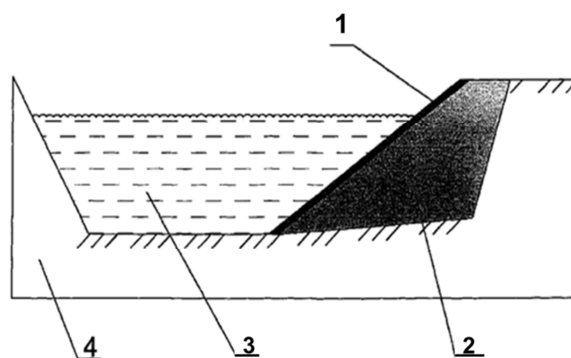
Конструкция водоотводного сооружения: 1 – металлическая подпорная стенка, 2 – конструкционный пенобетон, 3 – вода, 4 – грунт
